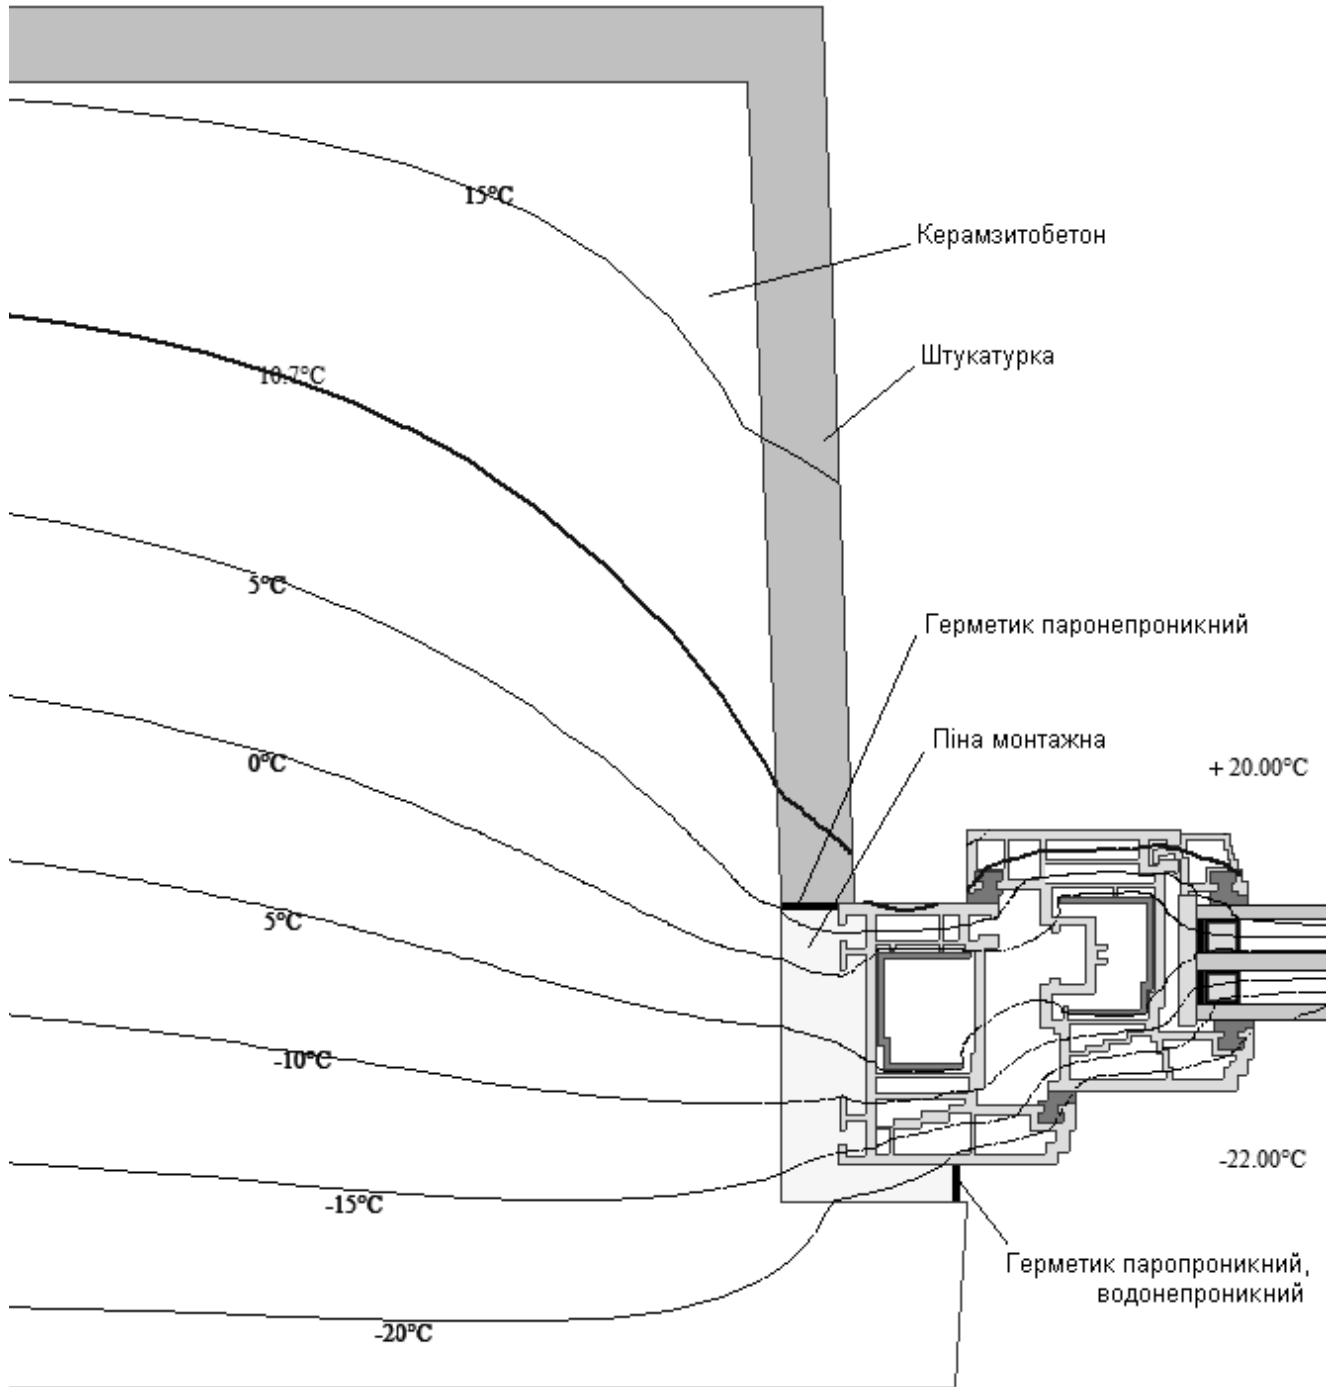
Узел бокового примыкания оконного блока с ПВХ профилей к стенового проема с четвертью к стене из легкого бетона (керамзитобетона) толщиной 350 мм
